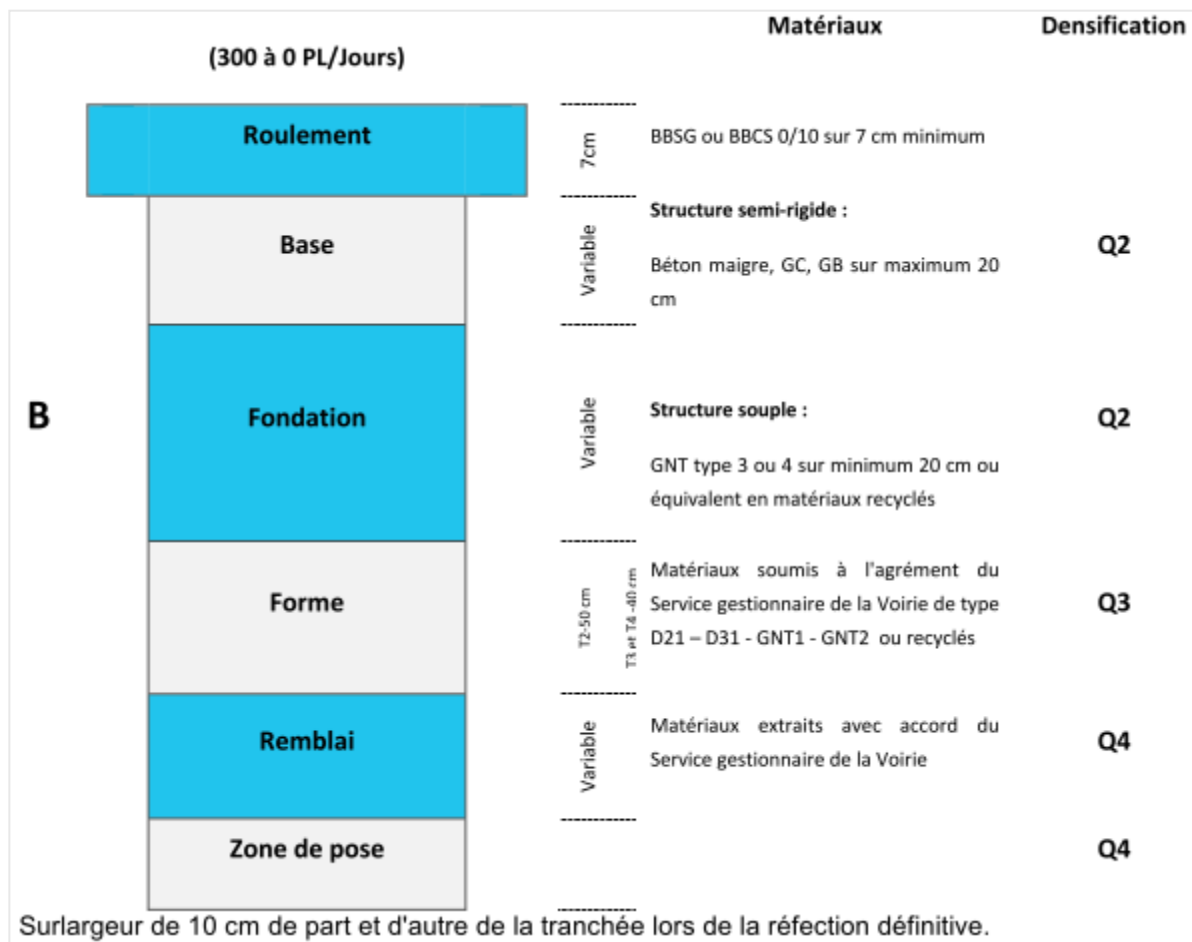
Structure de chaussée type - Extrait du Règlement de Voirie
